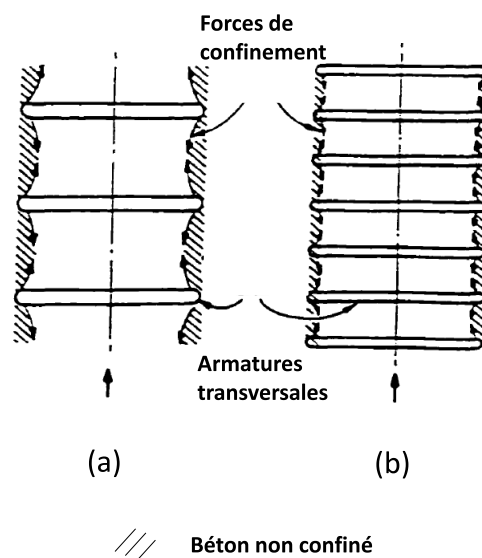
Espacement des aciers transversaux le long de la hauteur des poteaux (Park et Paulay (1975)).
